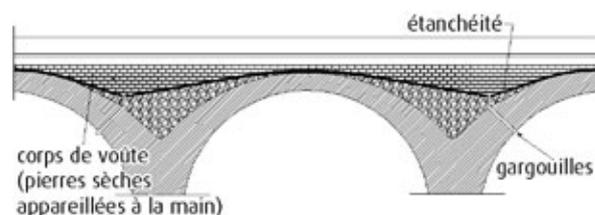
Exemples d'étanchéité basse sur un pont en maçonnerie
